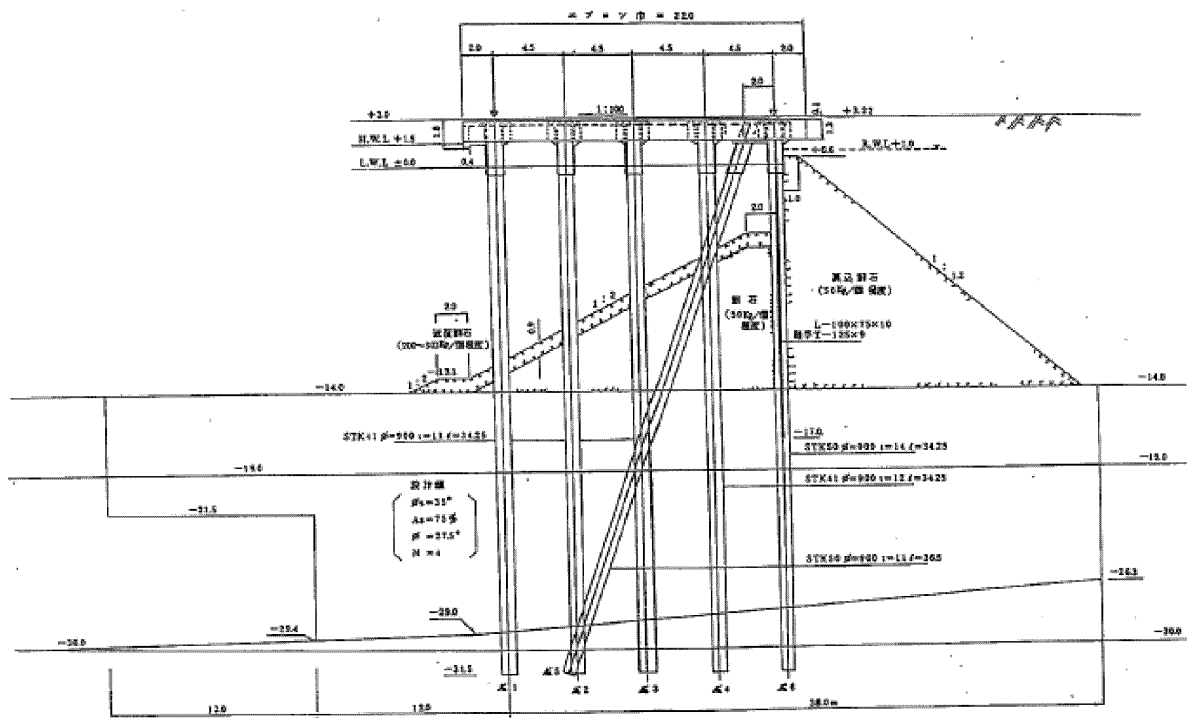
野々田地区栈橋(-13m)の標準断面図
